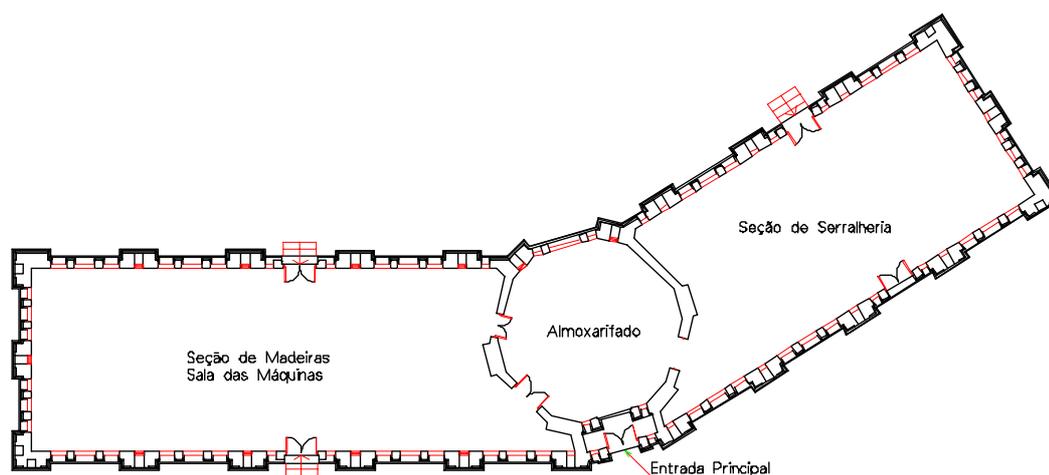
Planta Baixa do prédio do "Chateau" com suas funções iniciais.
